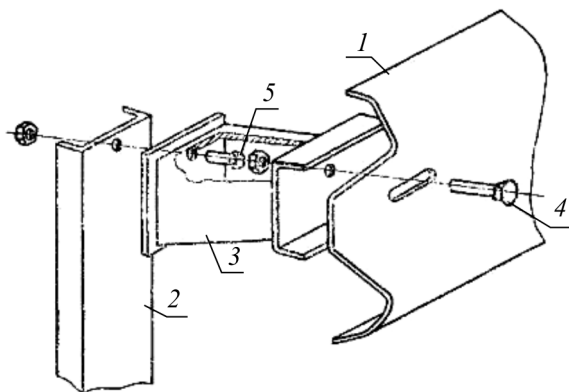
Детали соединения балки со стойкой для дорожных ограждений: 1 – балка; 2 – стойка; 3 – консоль жесткая; 4, 5 – болты
